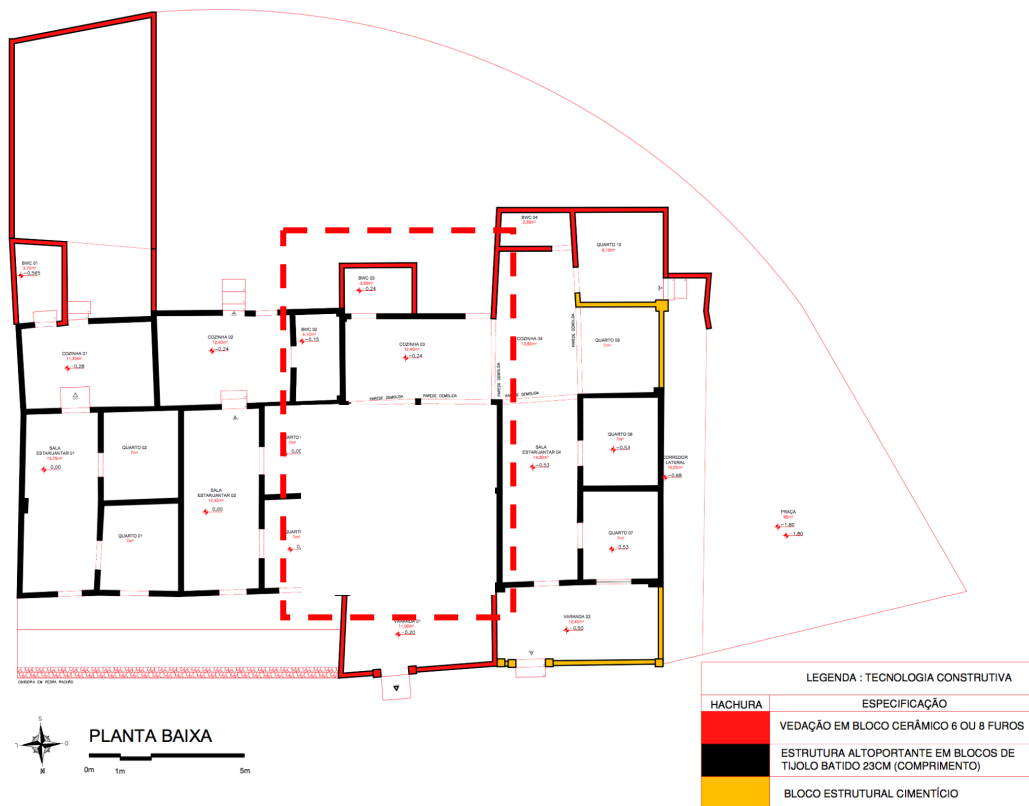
Planta baixa com definição dos sistemas construtivos. Destaque para a edificação 199.
